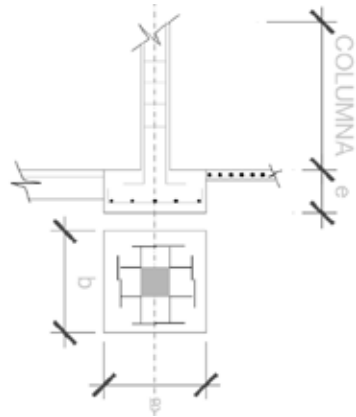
Detalle de Fundación. Fuente El Autor J.P. (2013)
